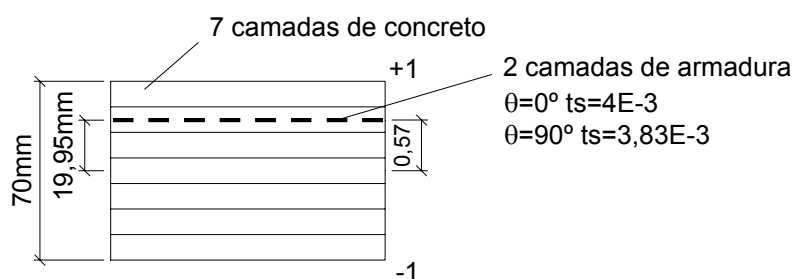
Esquema das camadas de concreto e aço da laje da viga mista
